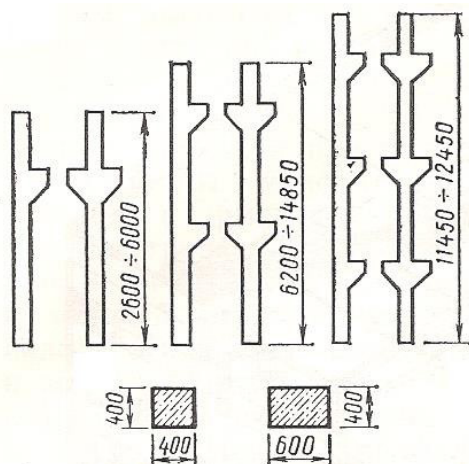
Железобетонные колонны многоэтажных производственных зданий
